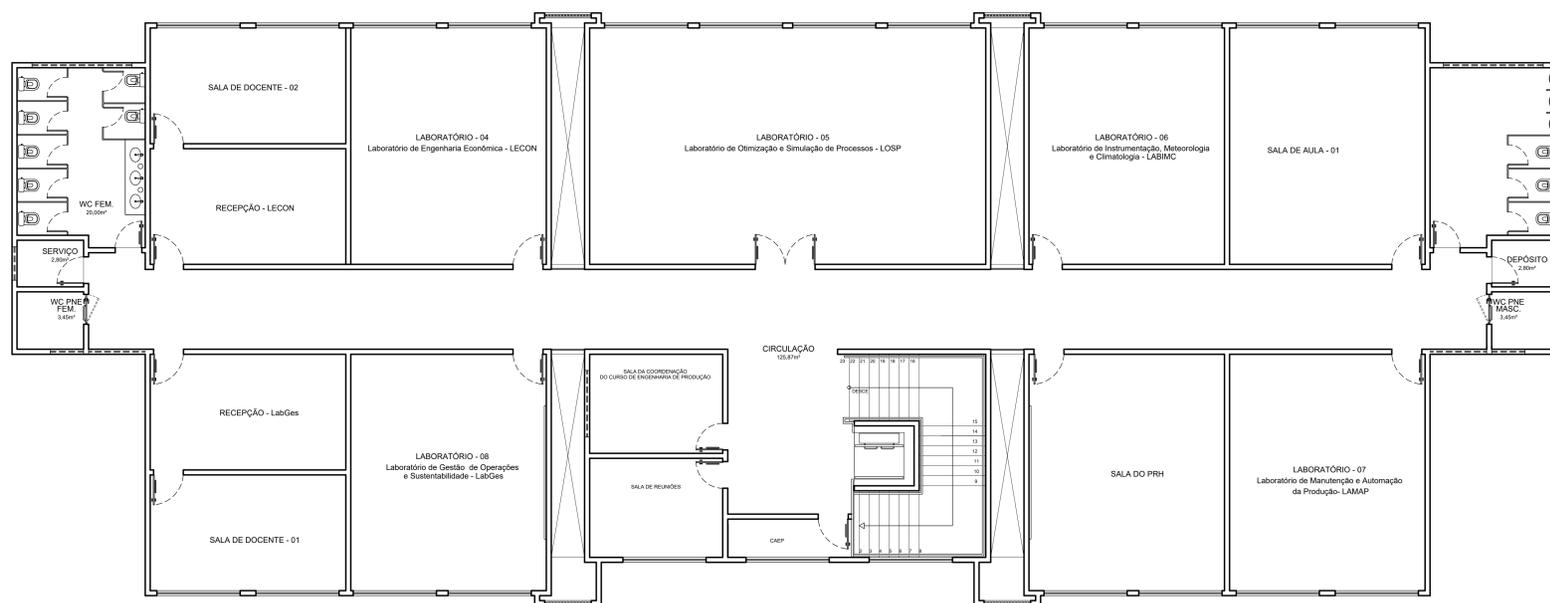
Reforço estrutural – Planta de localização das vigas metálicas
